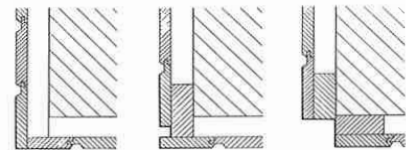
Assemblages d'angle pour revêtements de planches verticales.
